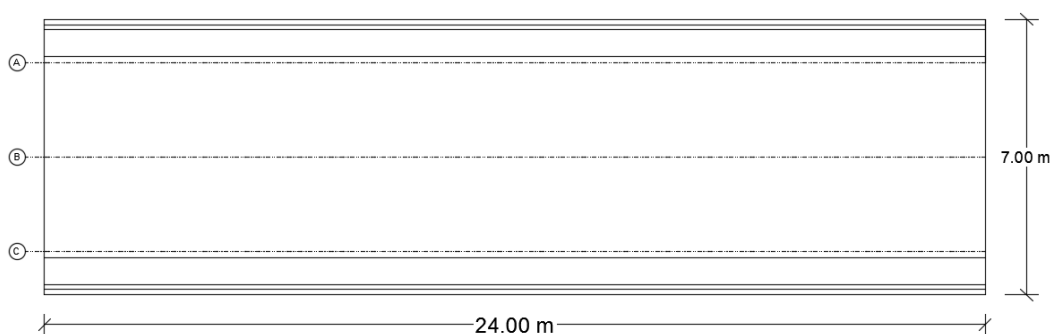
Vista en planta del tablero. Elaborado por: El autor
